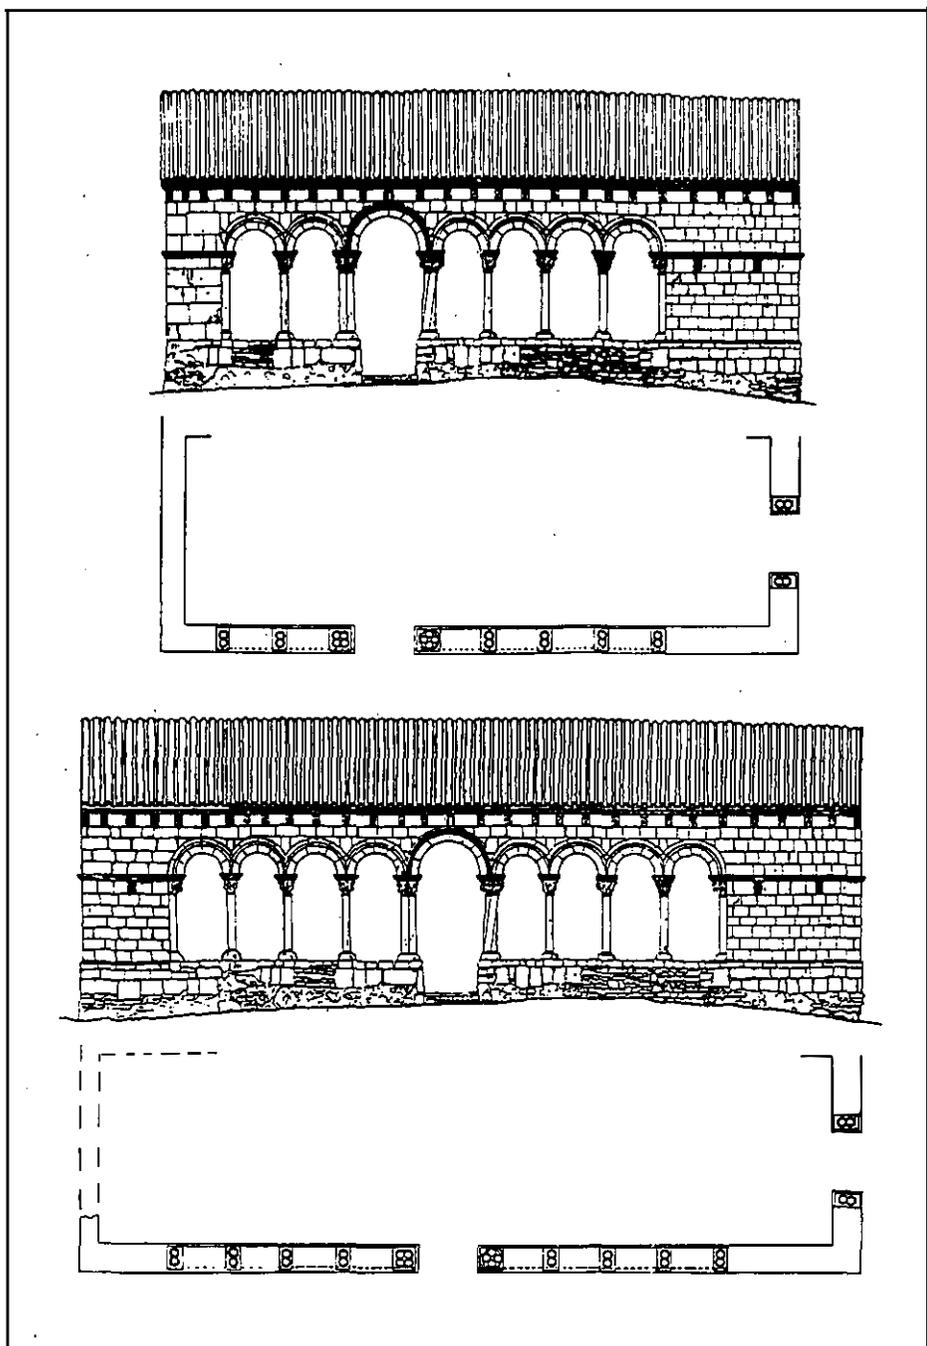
Alzado y planta de la galería porticada actual. Debajo reconstrucción hipotética de alzado y planta de la galería primitiva.
